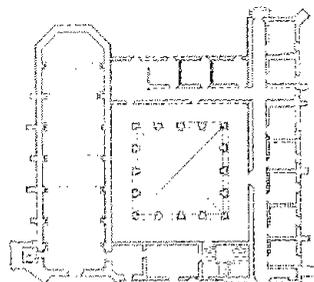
(derecha) Bóveda con pilastras, planta alta del templo del convento de Ocuilco, Morelos.
